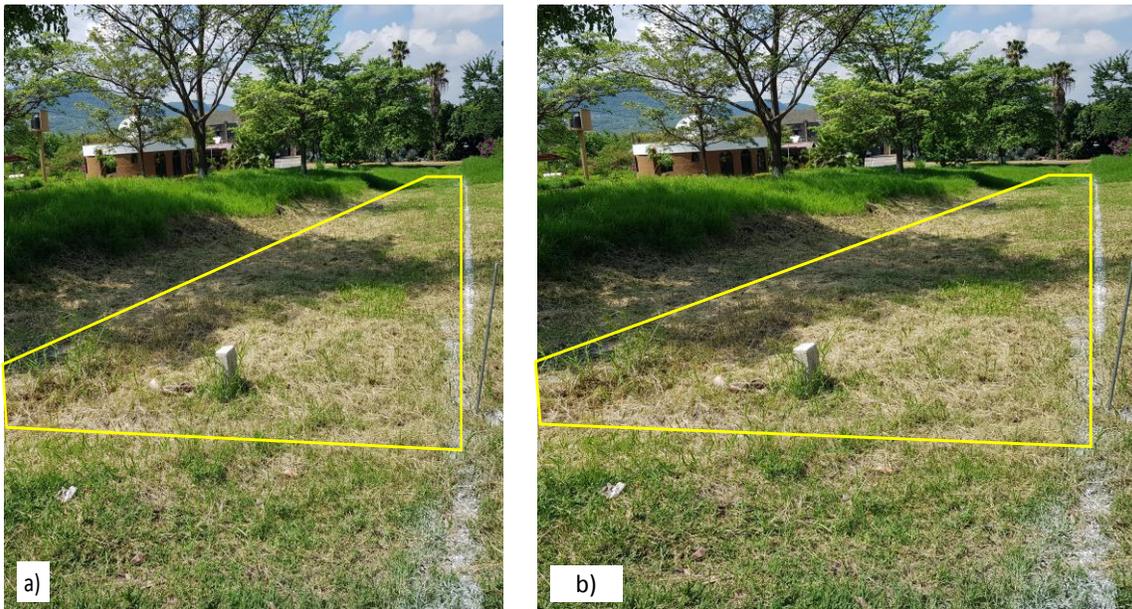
Ubicación del terreno. a) Vista de norte a sur. B) Vista de sur a norte.
